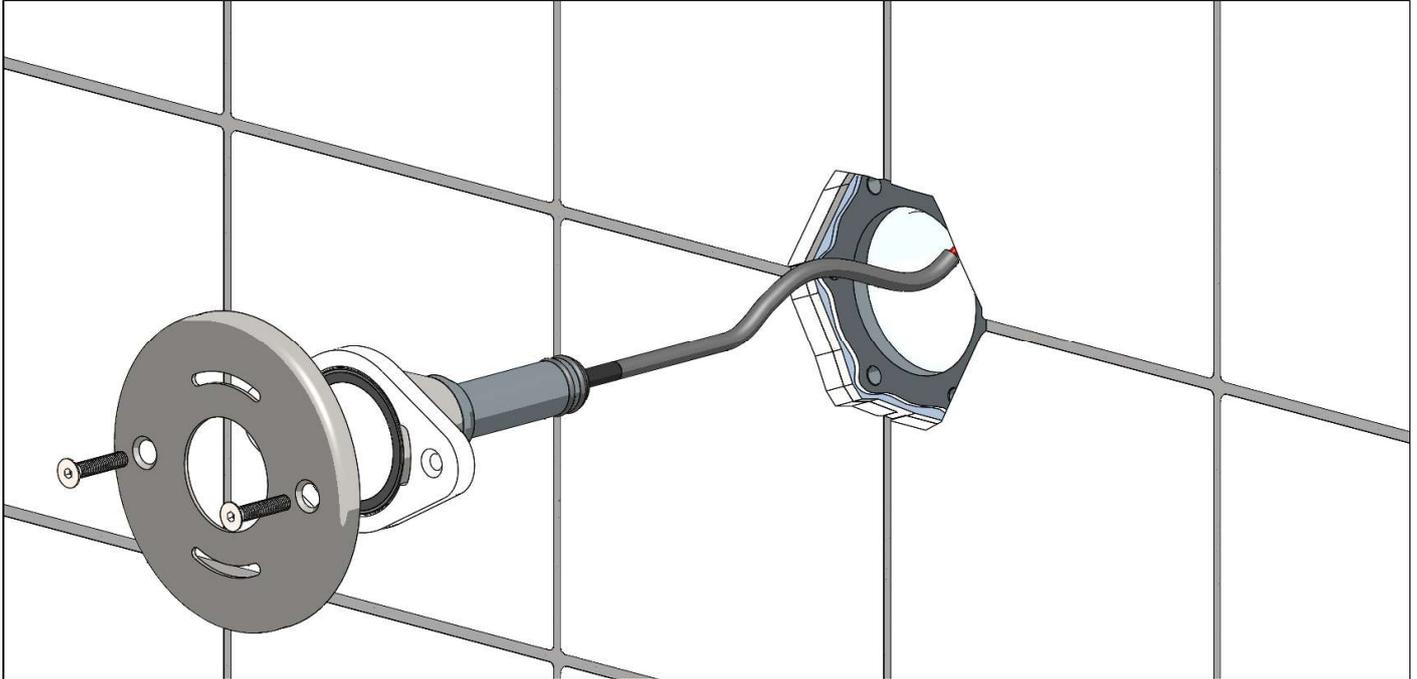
Kit de montage bassin béton (carrelé – avec et sans système d'étanchéité liquide)
